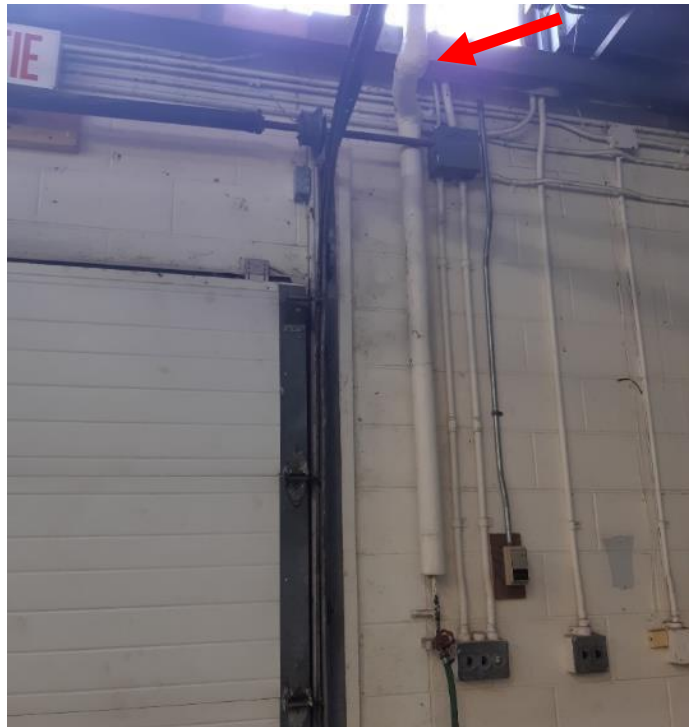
Rez-de-chaussée, pièce 1, sur le mur est au sud des portes de baie, un raccord dans un état passable.
